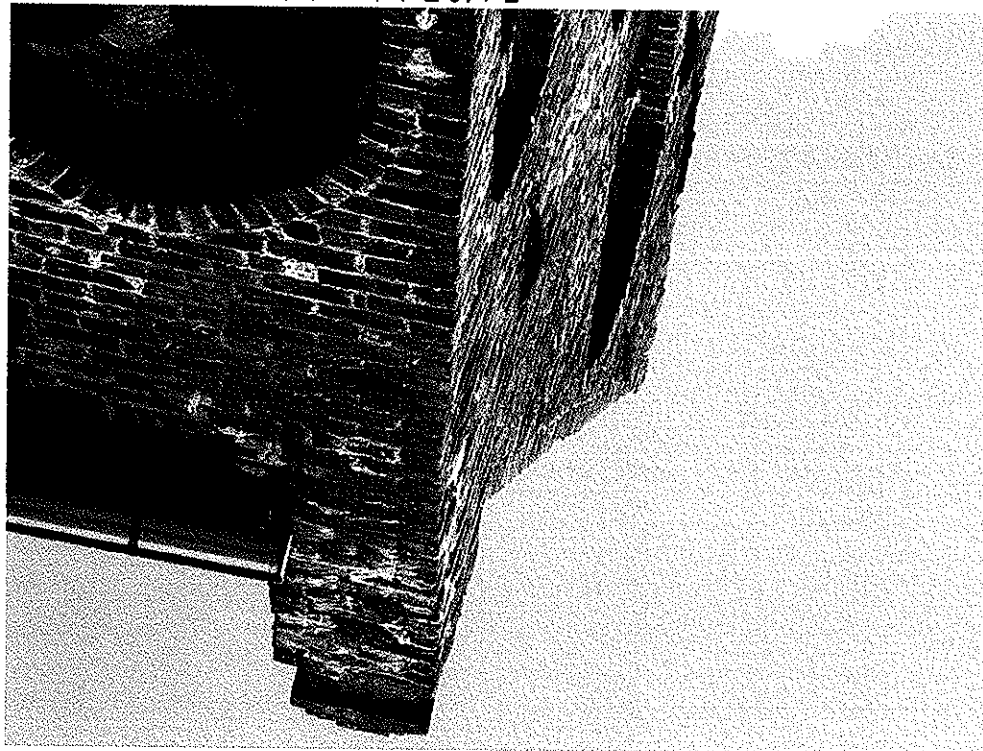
Strona wschodnia – bok źle zachowany, liczne naprawy cementowe, przemurowania do usunięcia
